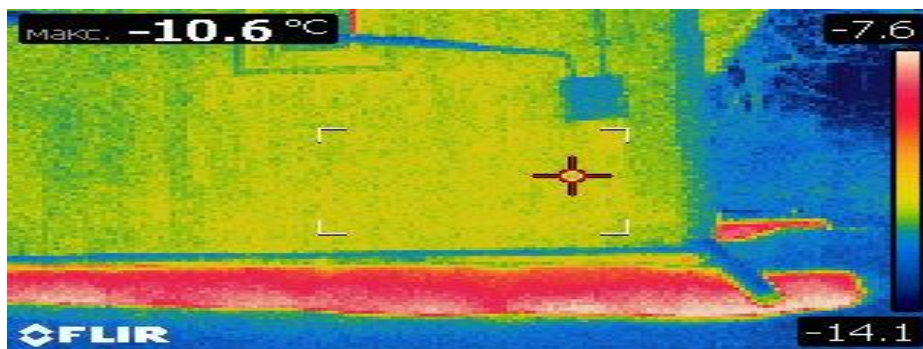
Фрагмент теплової зйомки фундаменту та бокової стіни будинку
